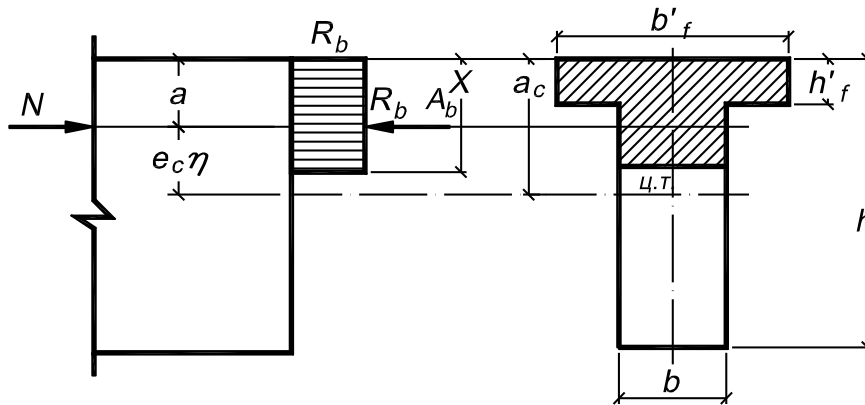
Схема зусиль і епюра напружень у перерізі, нормальному до поздовжньої осі позациентрово стиснутого бетонного елемента
